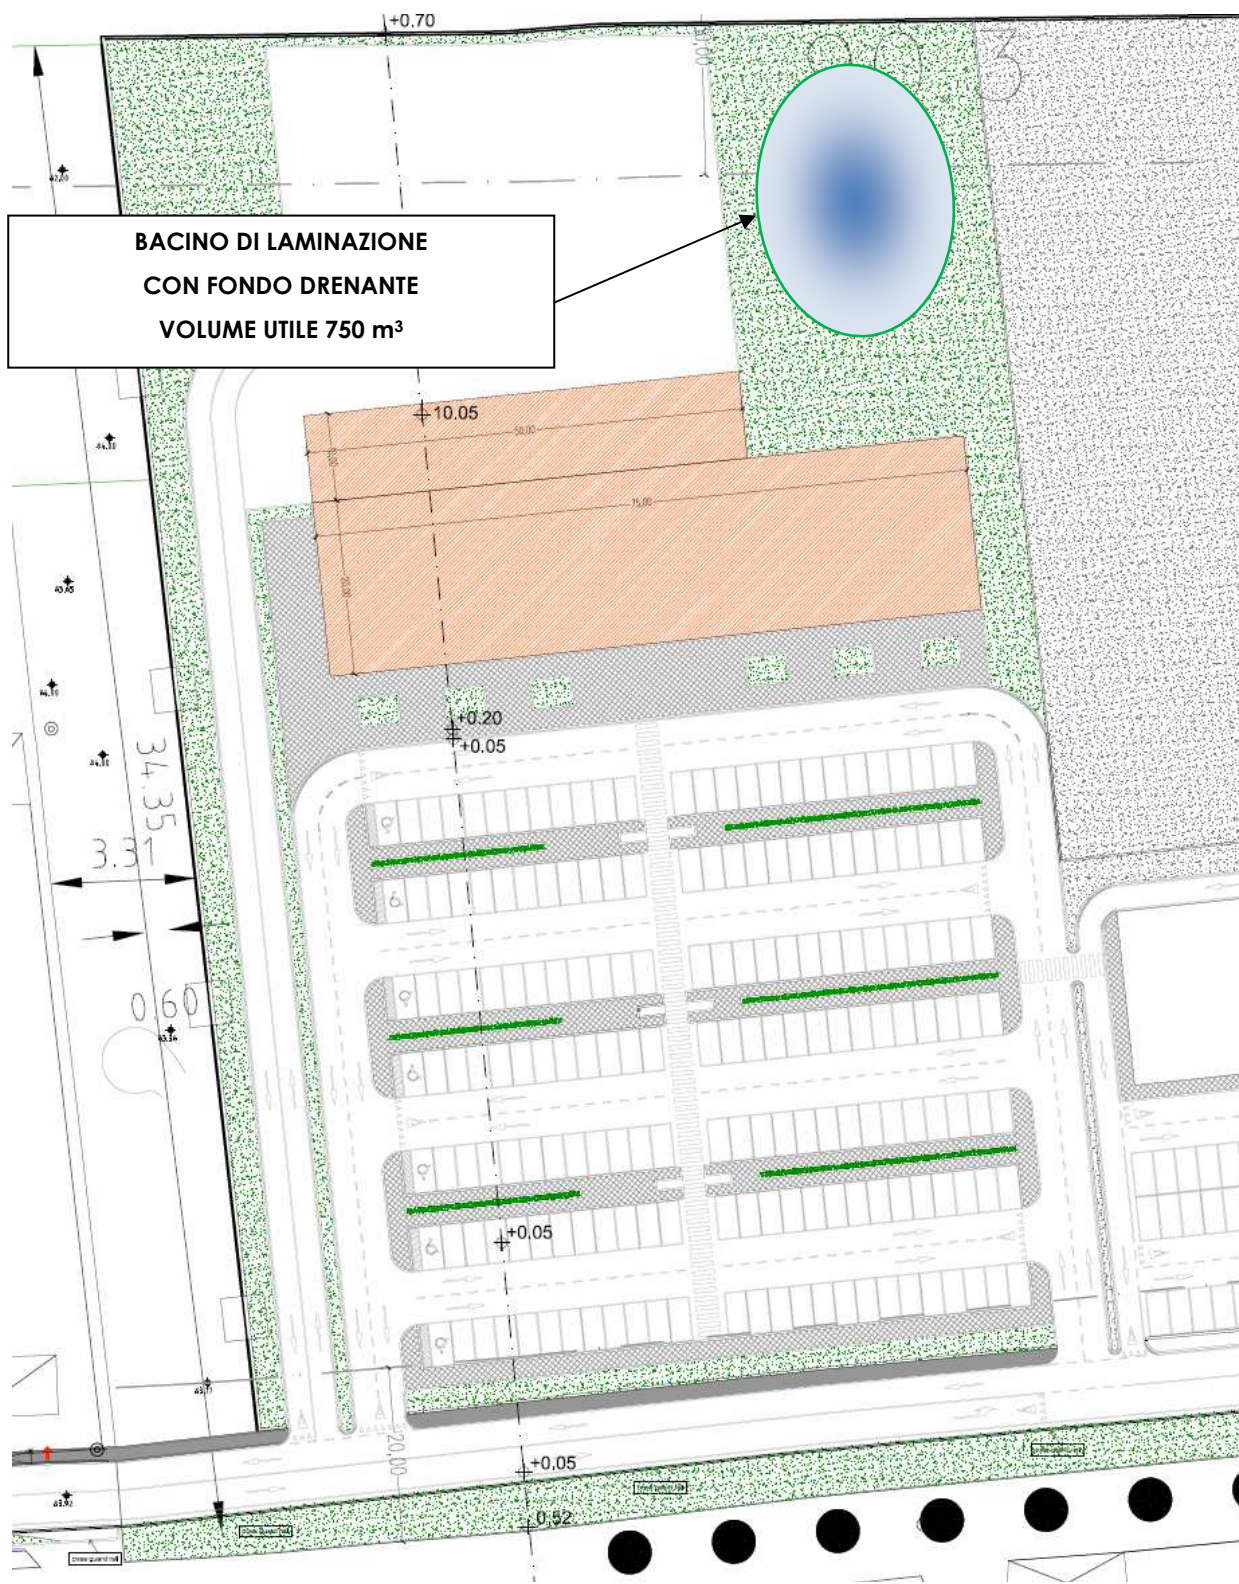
UBICAZIONE DELLA BACINO DI LAMINAZIONE DRENANTE A SERVIZIO DEL LOTTO 1 E 2
